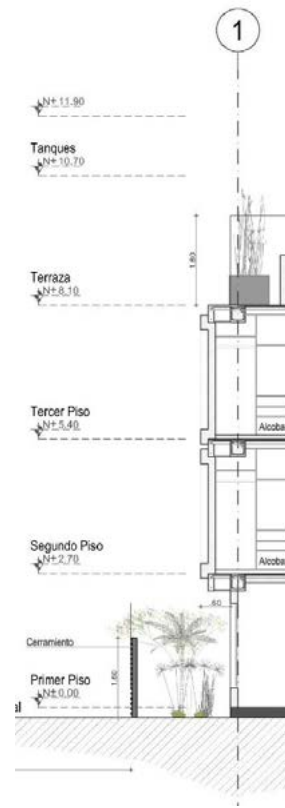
Fuente: (Porter & Greenstreet, 1987)
